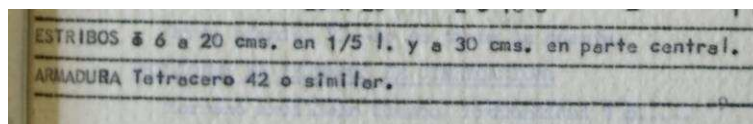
Leyenda de planos de estructura. Edificio ficha 204^a.015, 1969.
